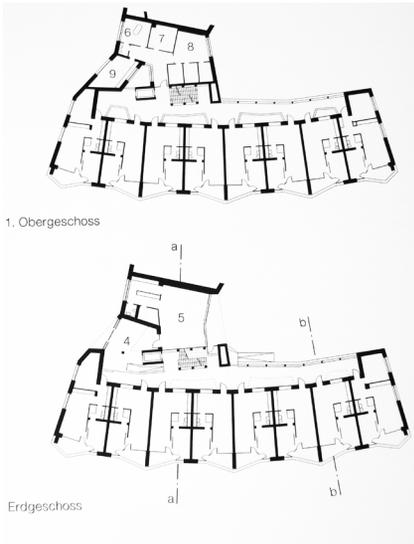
Siedlung Krone, Zürich, Grundriss
